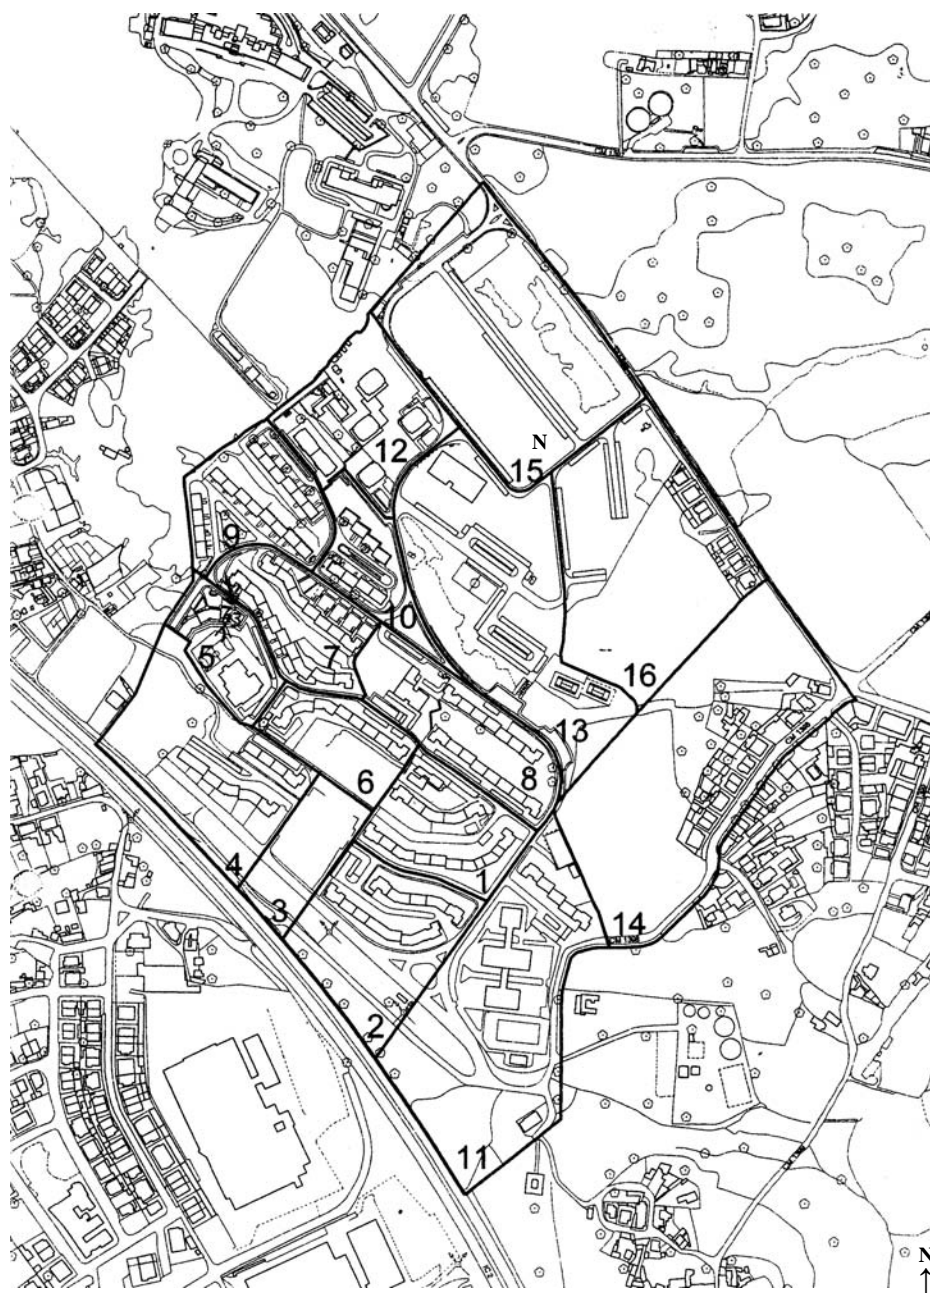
Planta Geral da Urbanização de Vila de Este.
